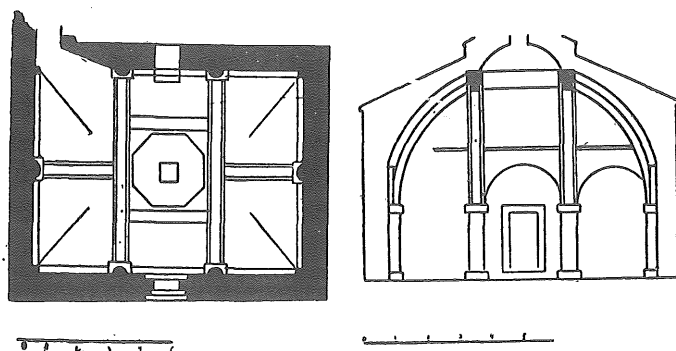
Aradesse (Armenia). Planta y sección del pórtico, según Baltrusaitis
